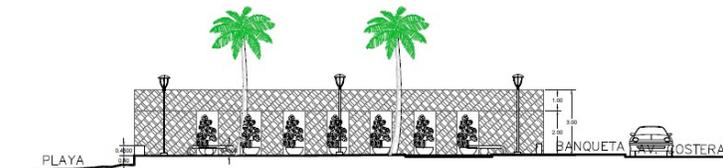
Planta arquitectónica del proyecto de parque y acceso a playa Karabali
